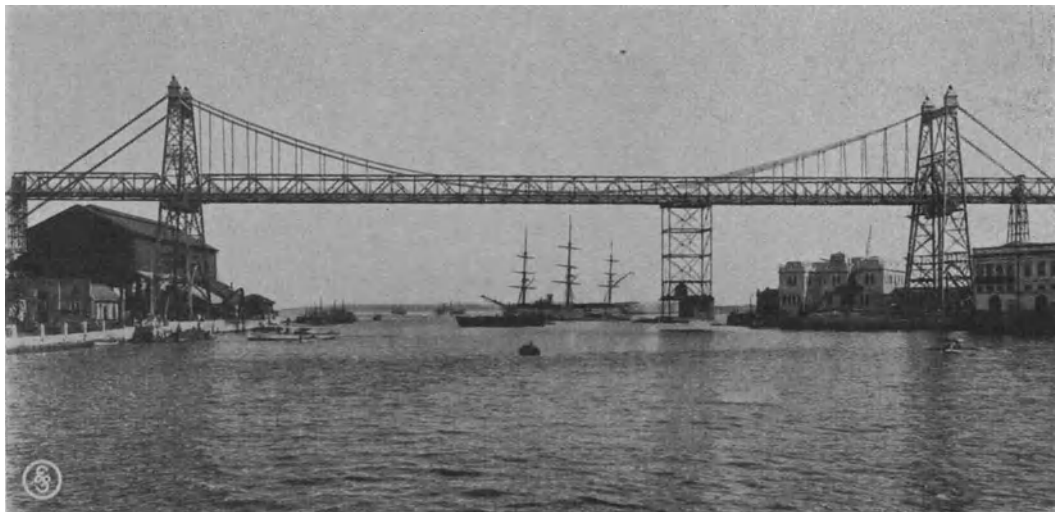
Hängebrücke mit elektrischer Schwebefähre.
